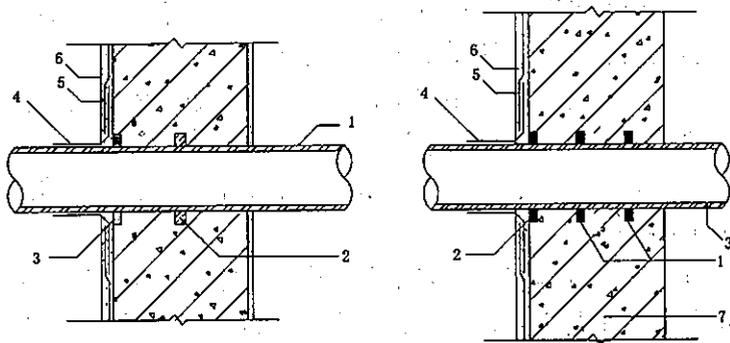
直埋式管道防水构造 (一) 图 4.3.8-10 直埋式管道防水构造 (二)
